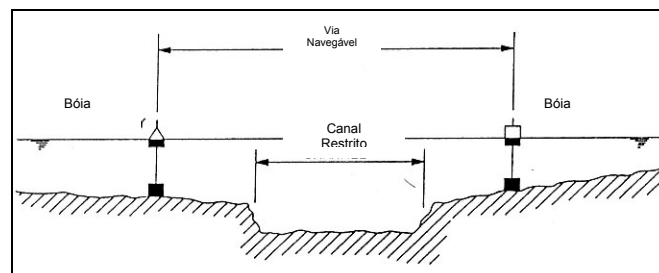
Definições de Canal Restrito e Via Navegável
